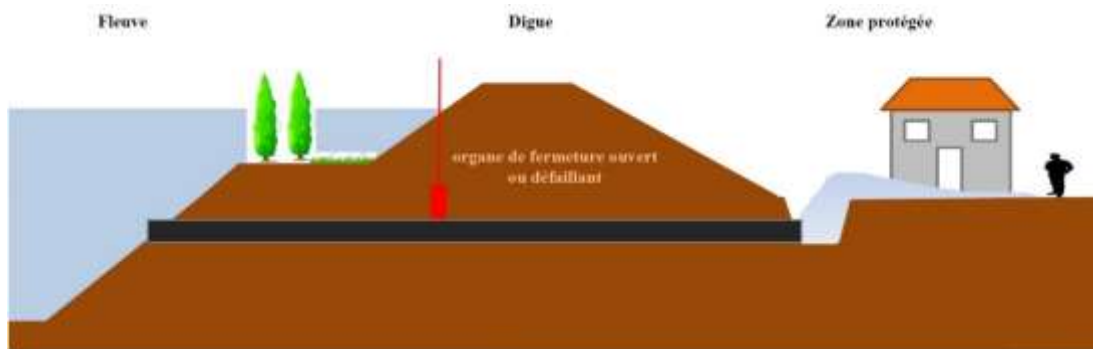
Cas n°2 : Défaillance d'un ouvrage hydraulique traversant
